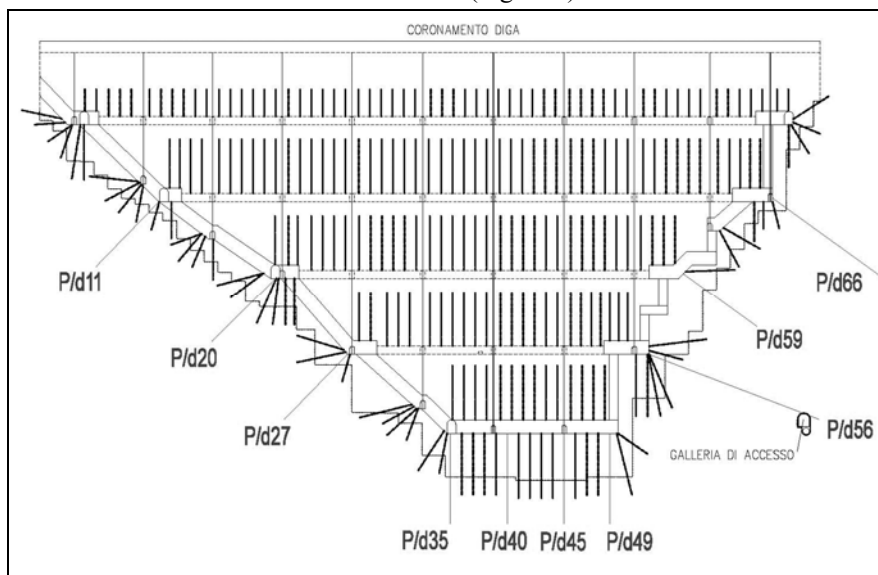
As built del nuovo sistema drenante. Profilo longitudinale con indicazione dei nuovi fori drenanti
